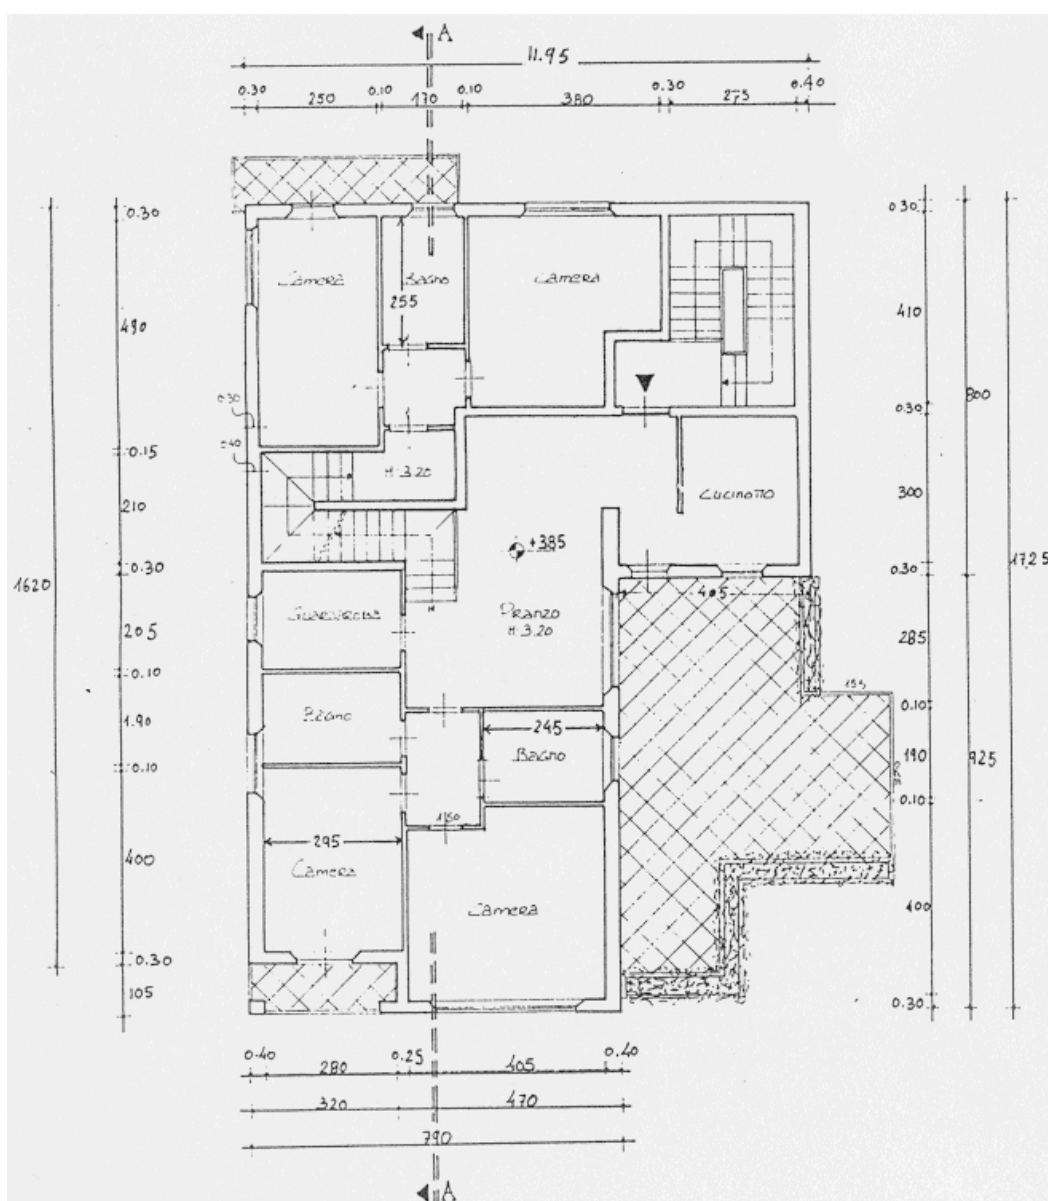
Pianta Piano Terreno Stato di Progetto.
